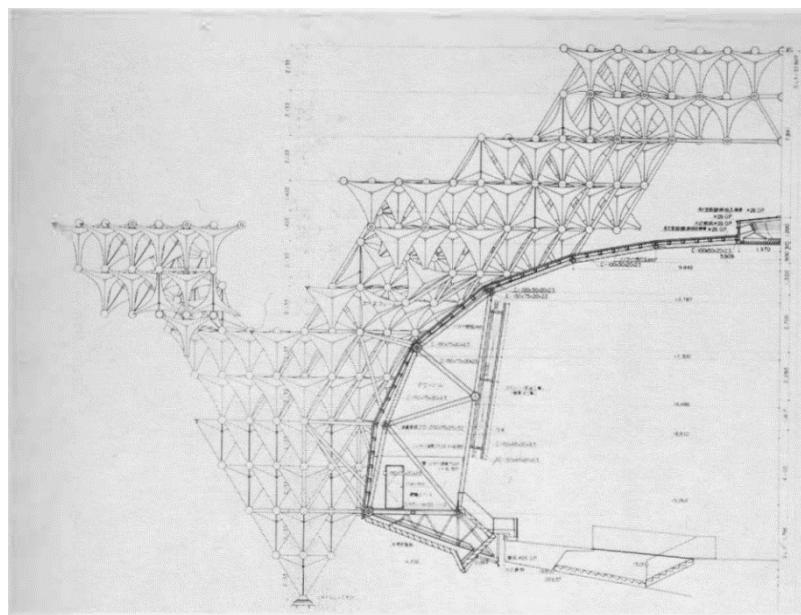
Sezione longitudinale del padiglione (K. Kurokawa, *Metabolism in Architecture*, Studio Vista, Londra, 1977, p. 129).
